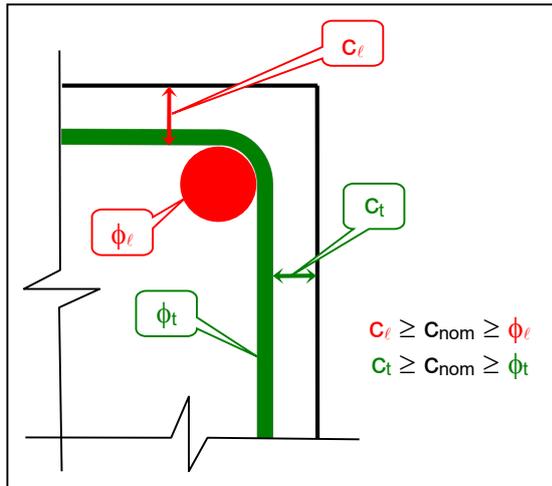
Cobrimentos de barras longitudinais e transversais
